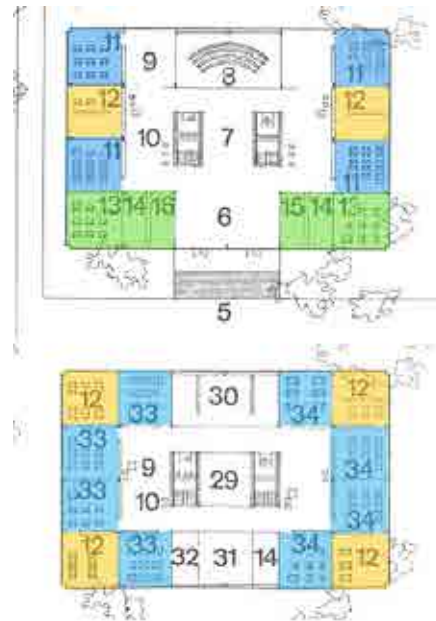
Planta del conjunto. ([s.n.] 1962f)
